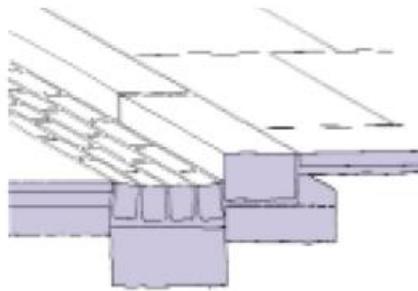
Principal tipo de pavimentação das calçadas de Londres.
